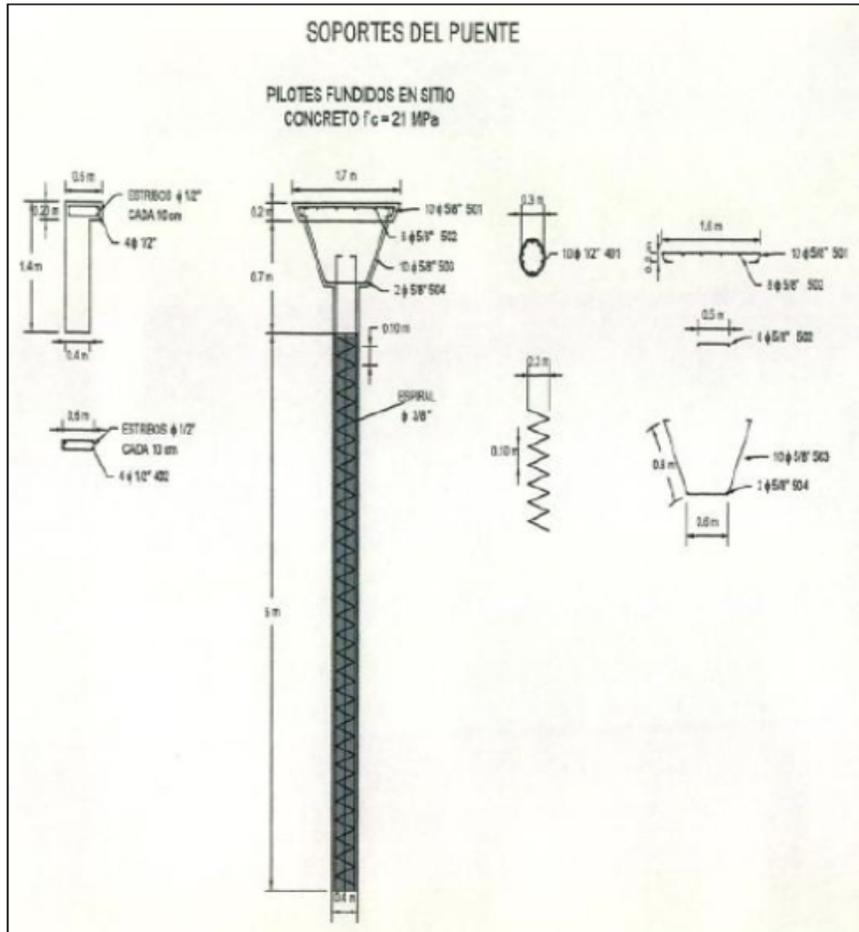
Planos perfil transversal de la base del puente construido sobre el canal Guaymaral.
